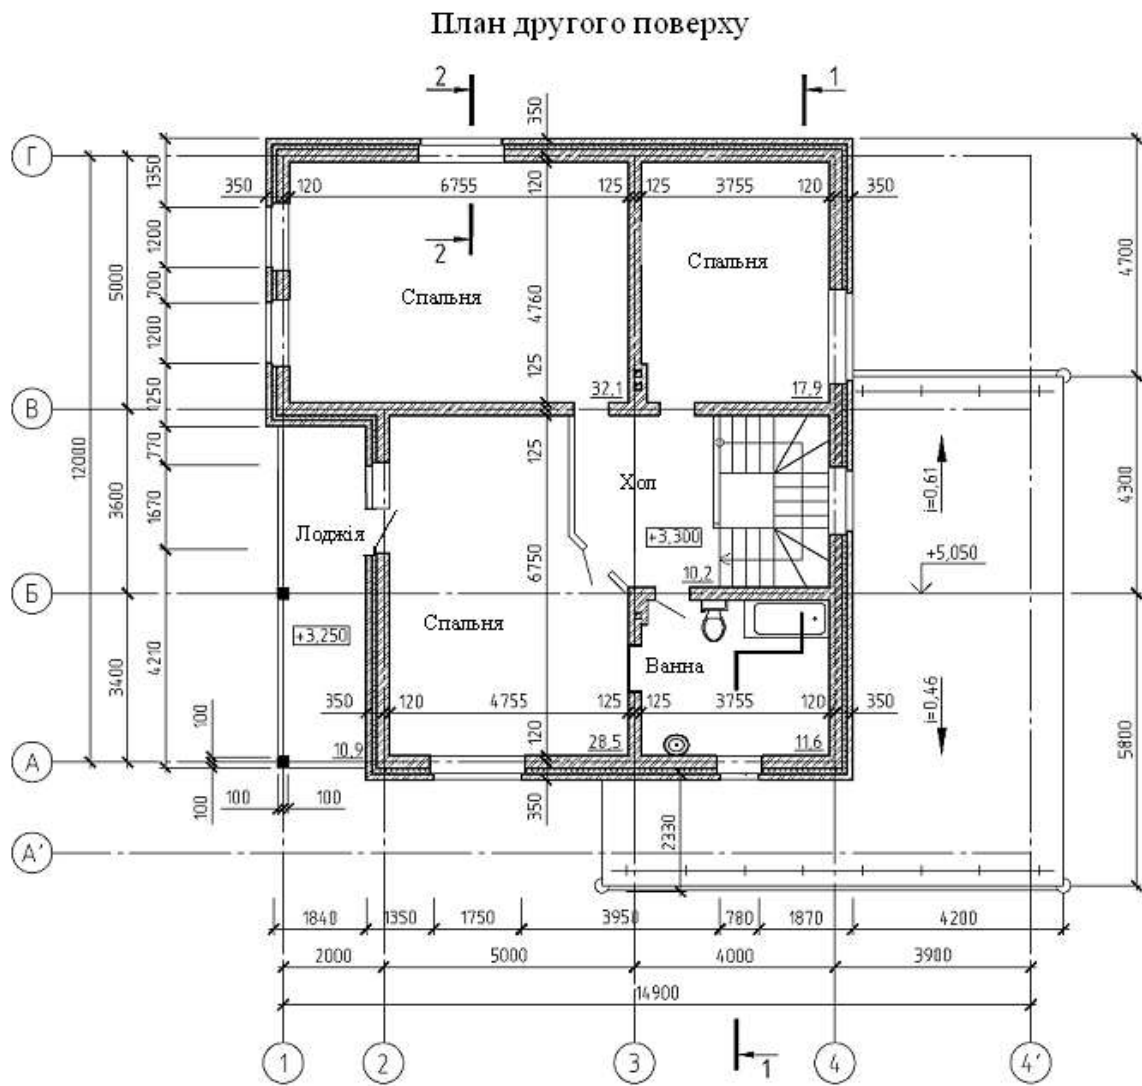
Приклад виконання плану 2-го поверху будівлі
